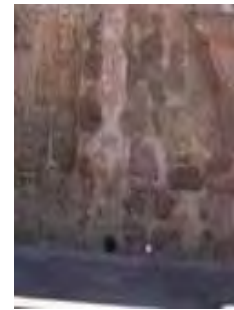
Colocación de junta y rellenos de mortero a base de cemento.
